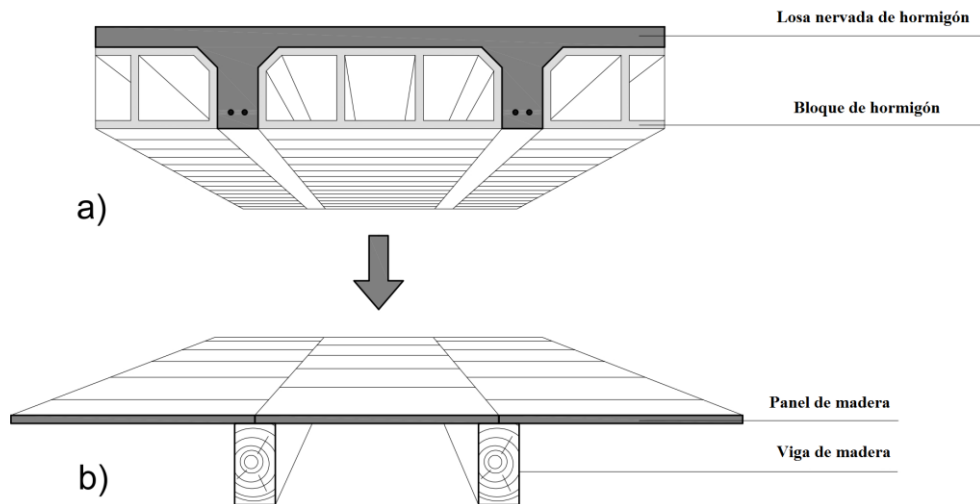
Sección de los forjados: (a) en el edificio original; (b) elemento alternativo propuesto.
